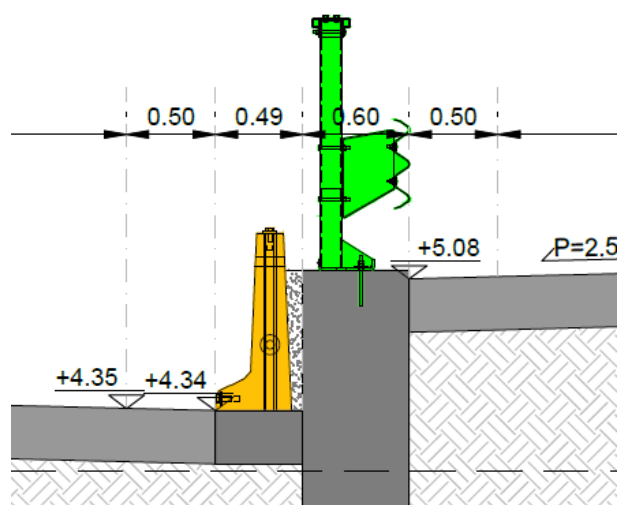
Particolare 1: Barriera metallica e profilo redirettivo.
